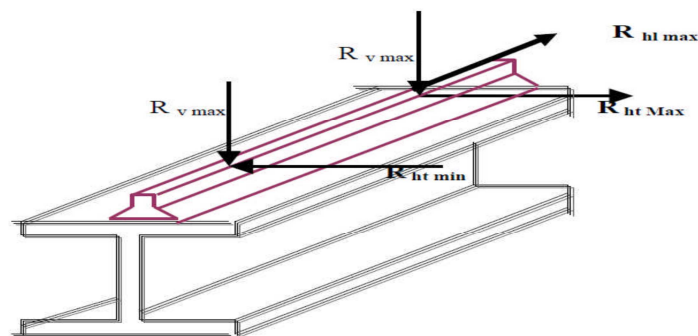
les forces horizontale et verticale appliquée sur la poutre de roulement.
